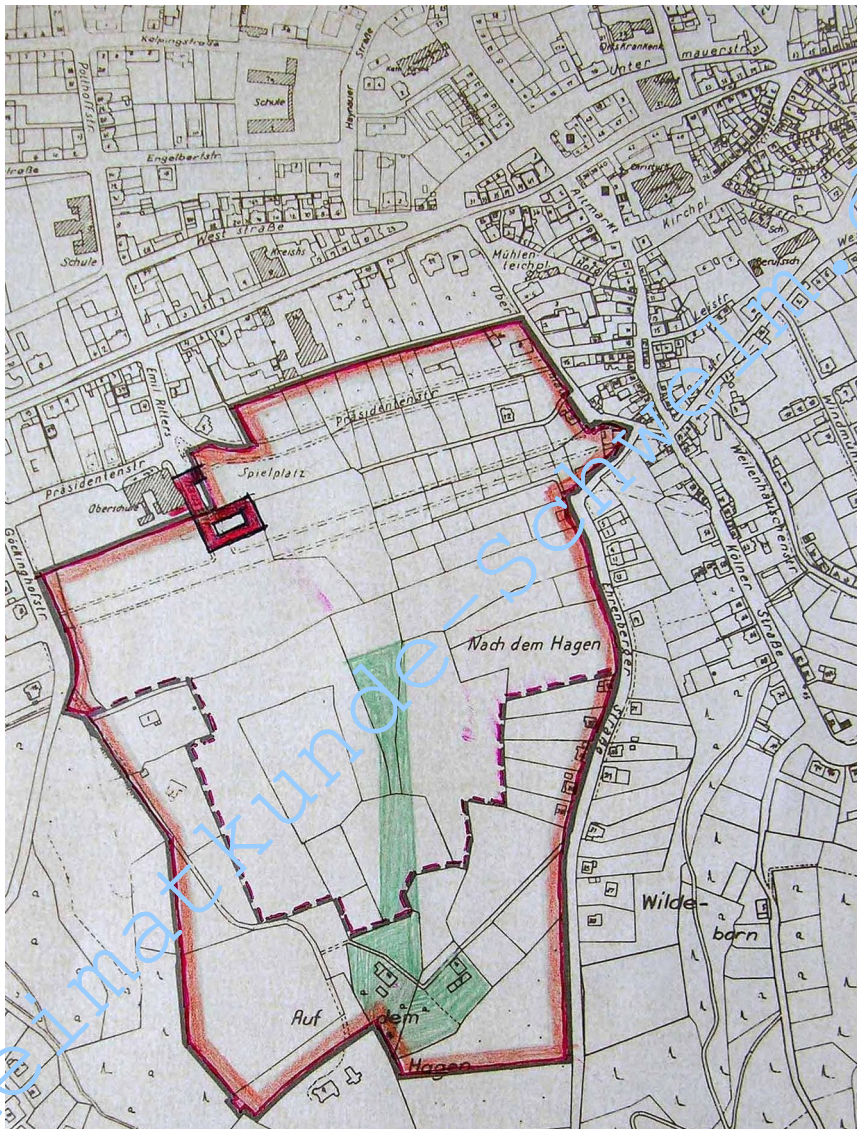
1. MGS-Erweiterung im Lageplan „Untern Hagen“, 1961
